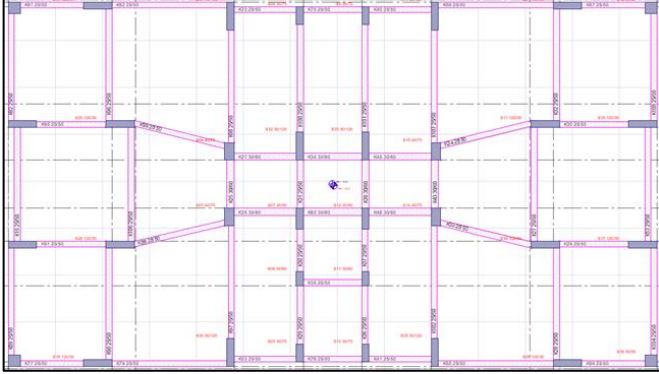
Yapıya bodrum perdesinin eklenmesi ile oluşturulan P3 planı
